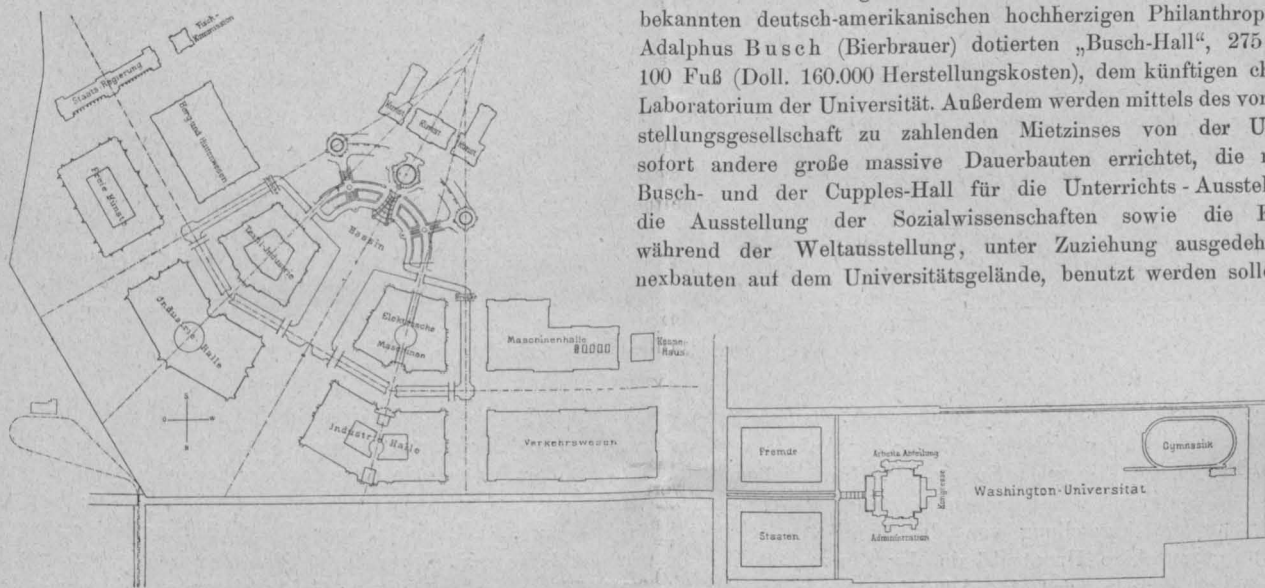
Lageplan der Weltausstellung St. Louis 1904. Maßstab 1 : 17.500.
